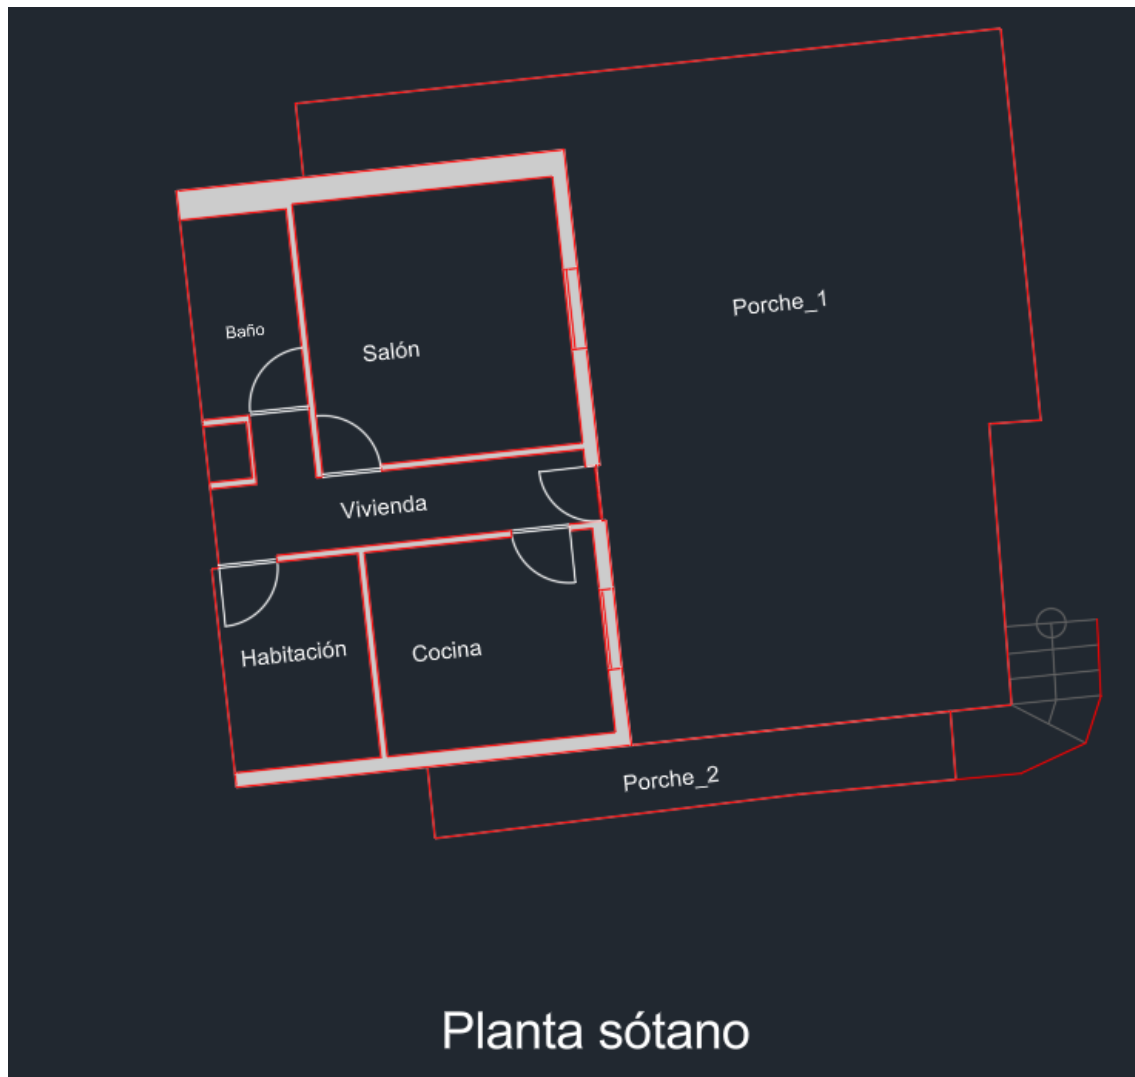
Dibujo de la planta sótano. Elaboración propia.
